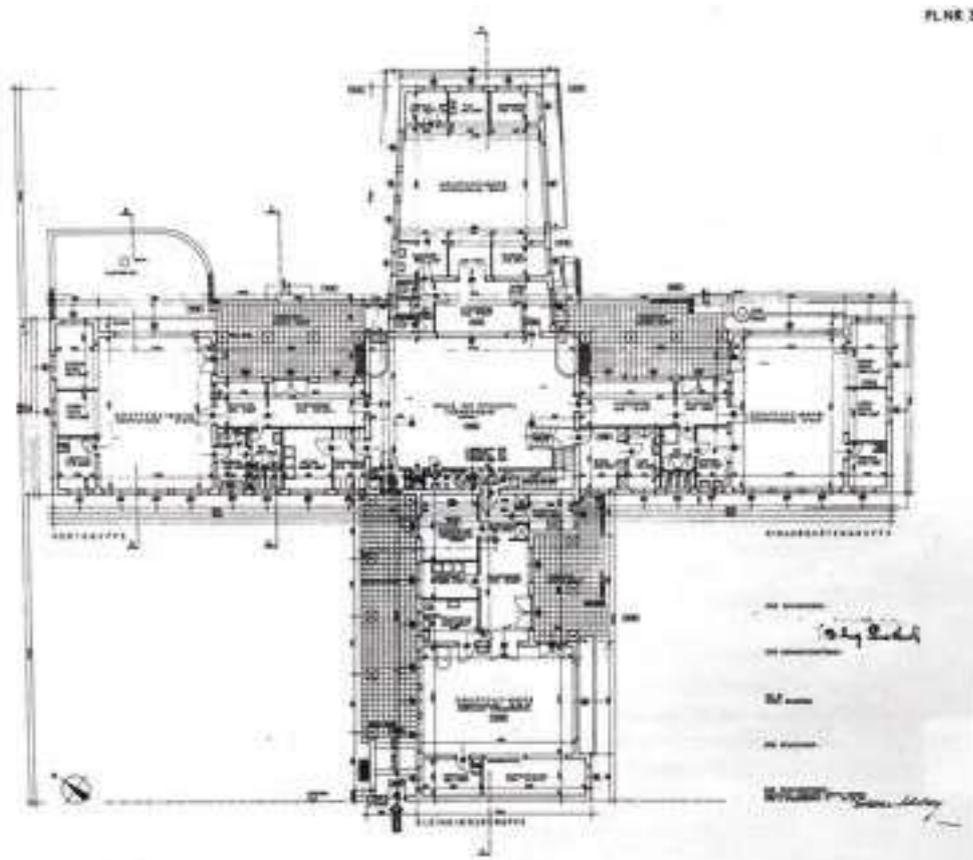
Der kreuzförmige Grundriss des Kindergartens in der Rinnböckstrasse wurde von Margarete Schütte-Lihotzky entworfen und in den Jahren 1961-1963 errichtet.
